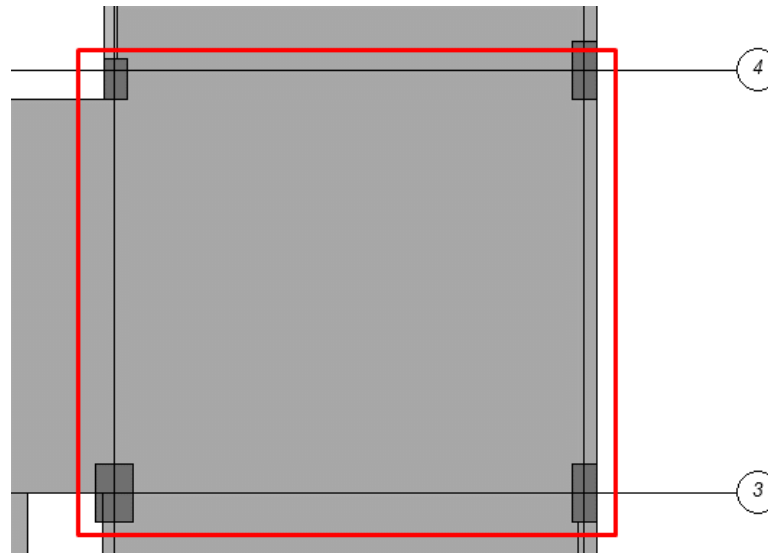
Vista en planta losa entre los ejes 4-3 y B-C
